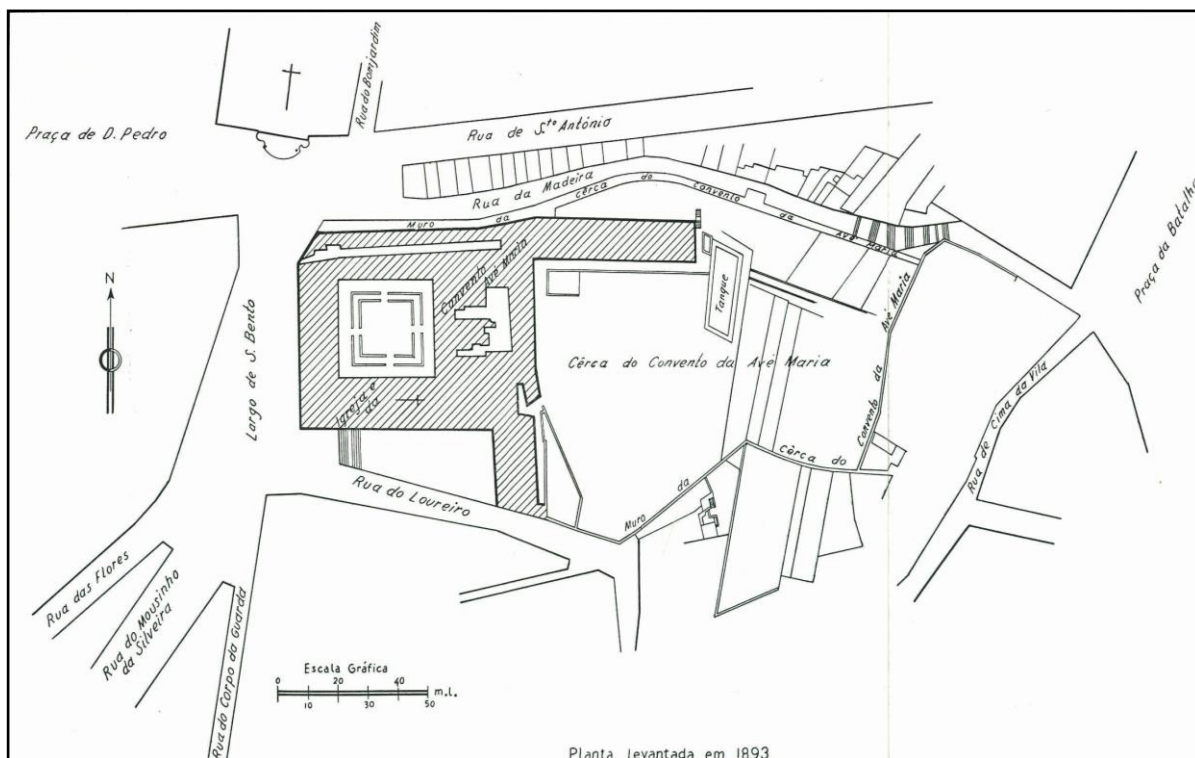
Planta do Mosteiro de S. Bento de Ave-Maria levantada em 1893
